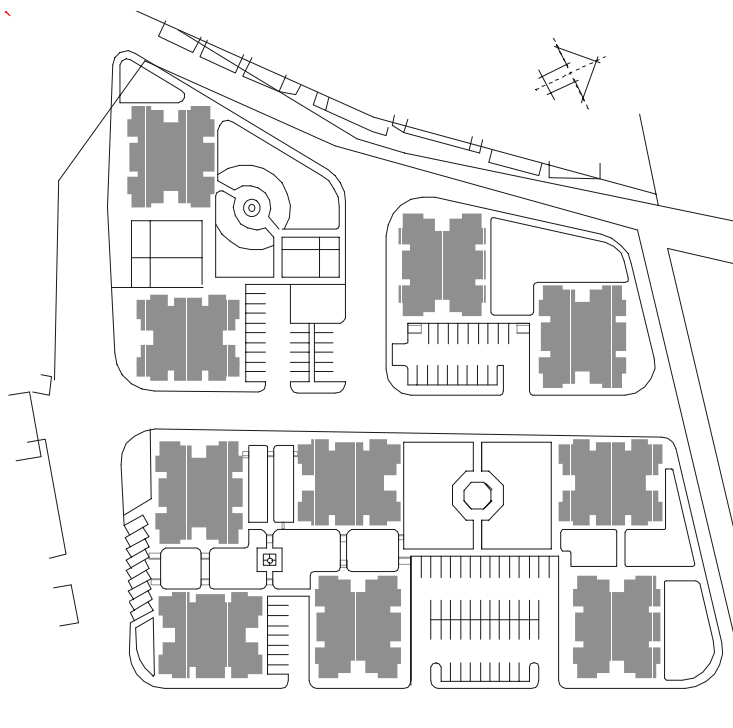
PHC, "Ain Jalout"-Wohnsiedlung, Grundrisse und Lageplan
